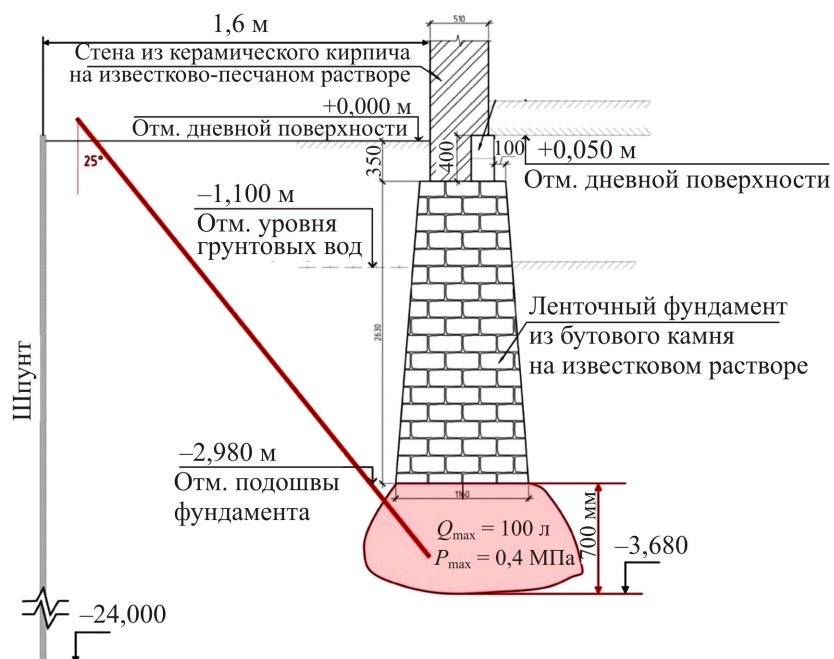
Схема компенсационного нагнетания саморасширяющегося материала на цементной основе с модифицирующими добавками в основание фундаментов здания
